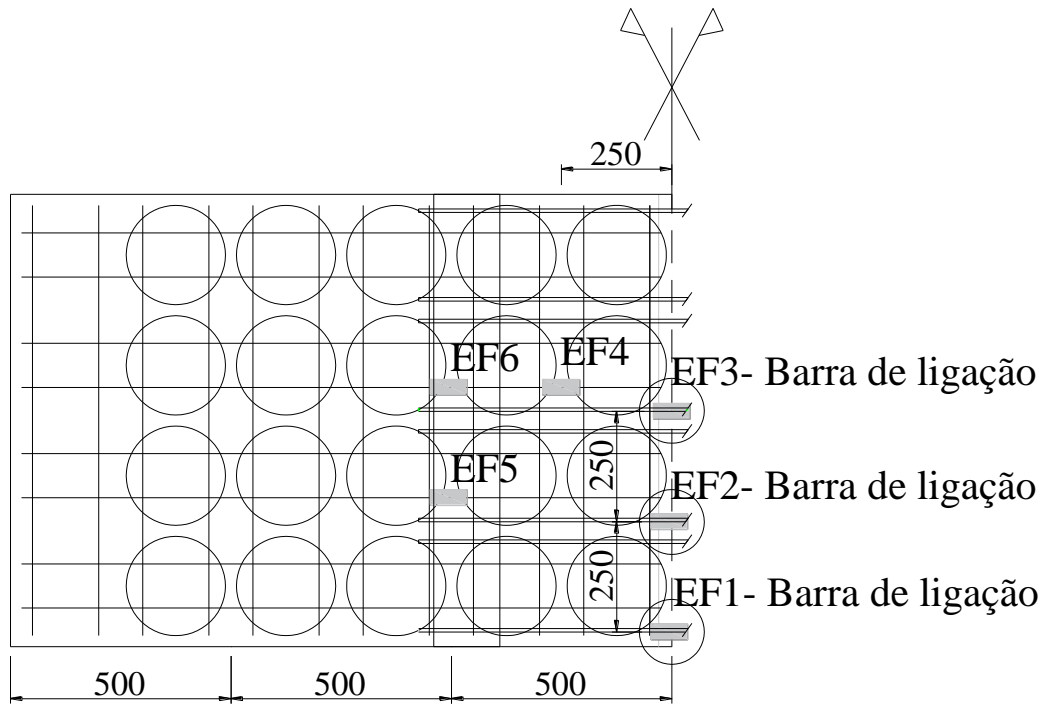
Extensômetros nas barras de aço da laje BD28-F2
